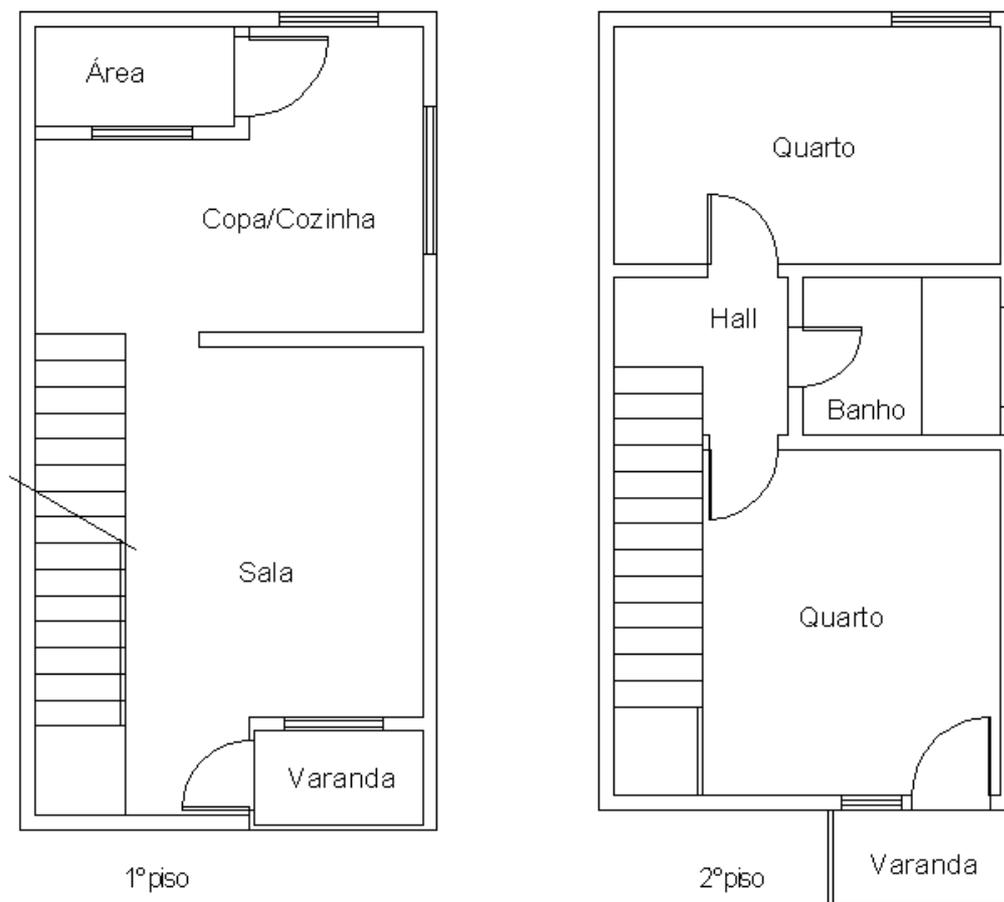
34 Planta baixa das casas geminadas de 2Q (1º e 2º piso)
